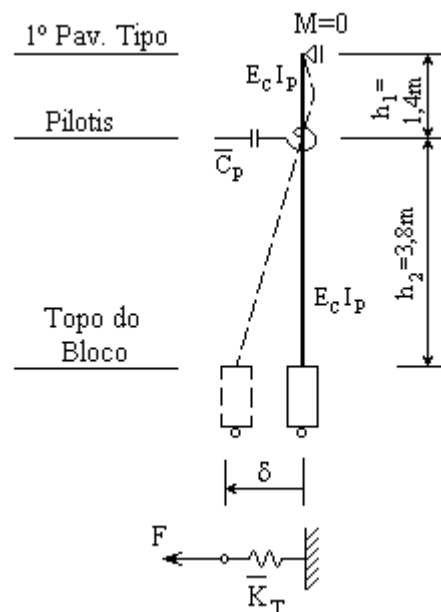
Rigidez à flexão do conjunto Pilar + Viga T
